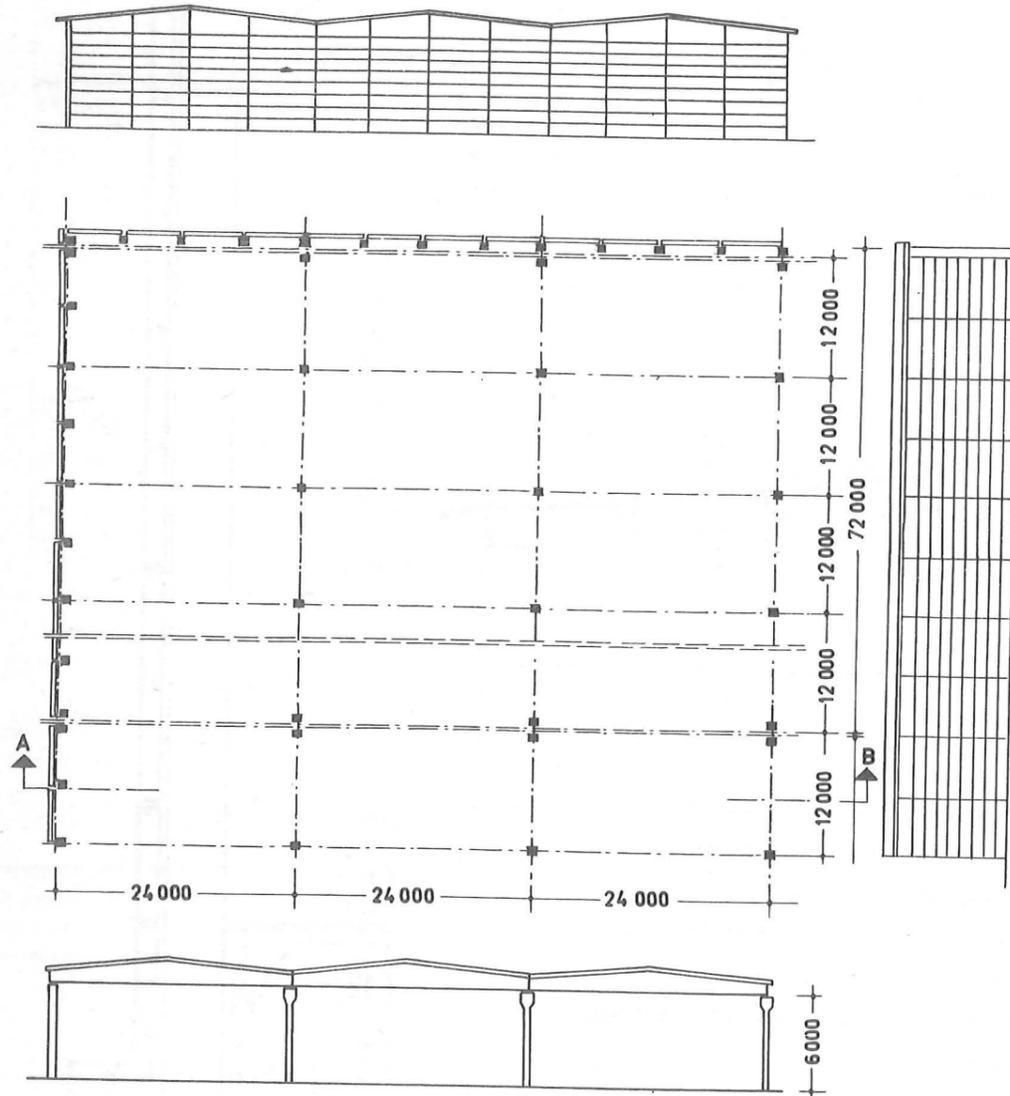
Eingeschossiges Gebäude mit Satteldach, Achsabstand 12000 mm
